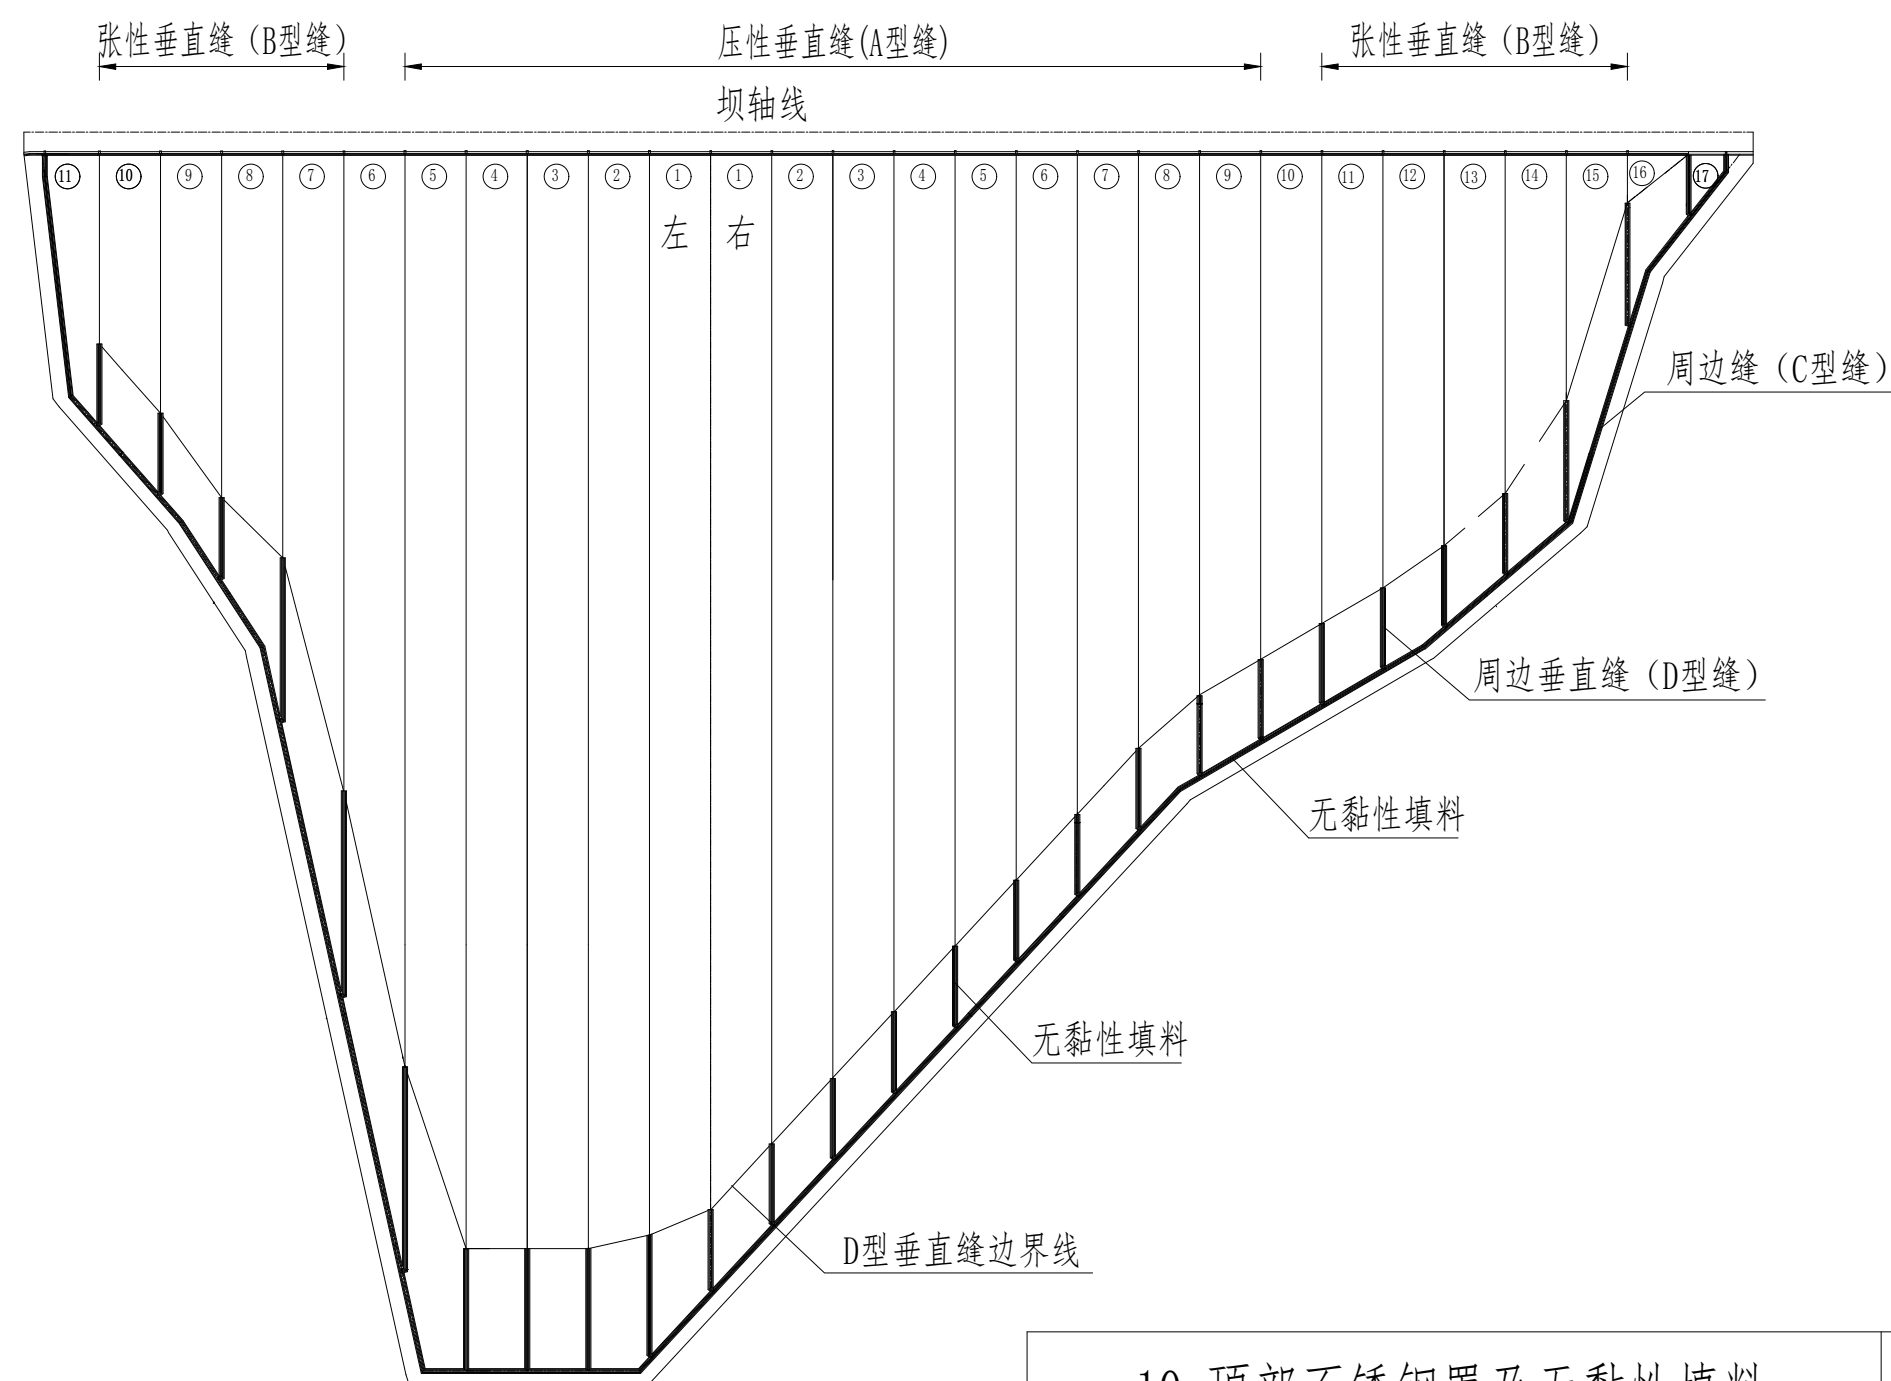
基岩上面板堆石坝无黏性填料止水平面图
